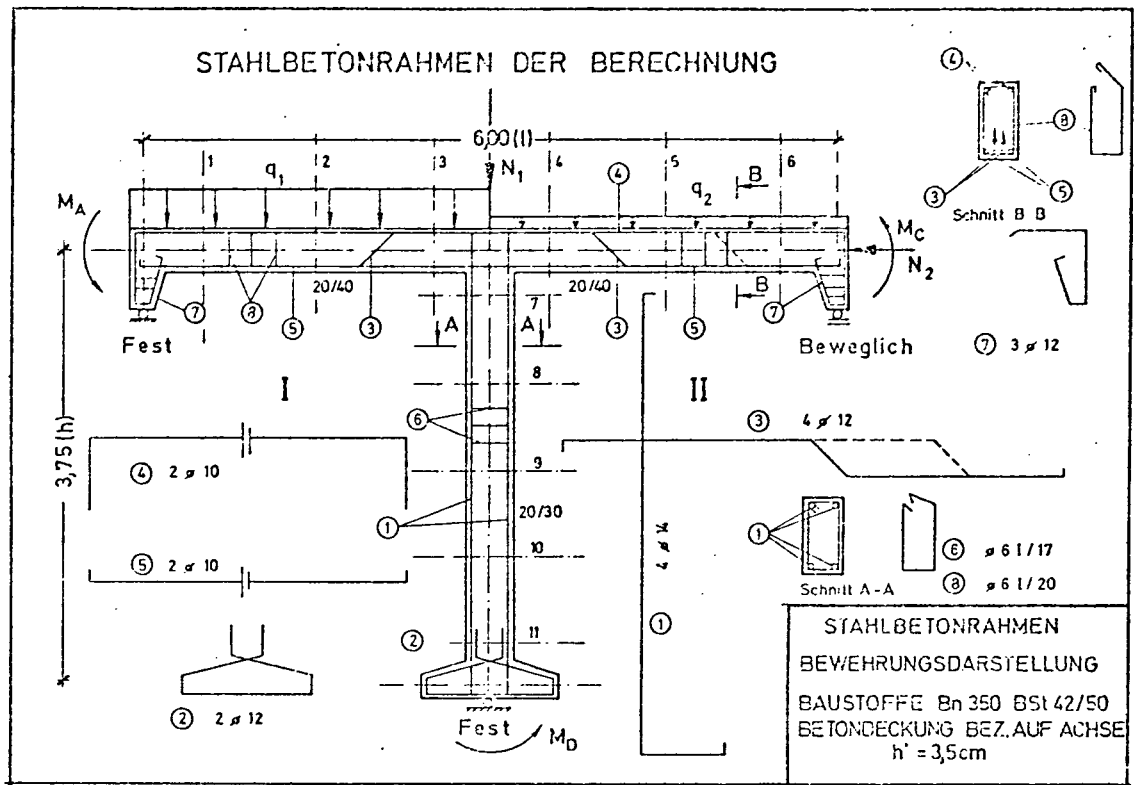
Geometrie und Bewehrungsführung des untersuchten Stahlbeton-T Rahmens
